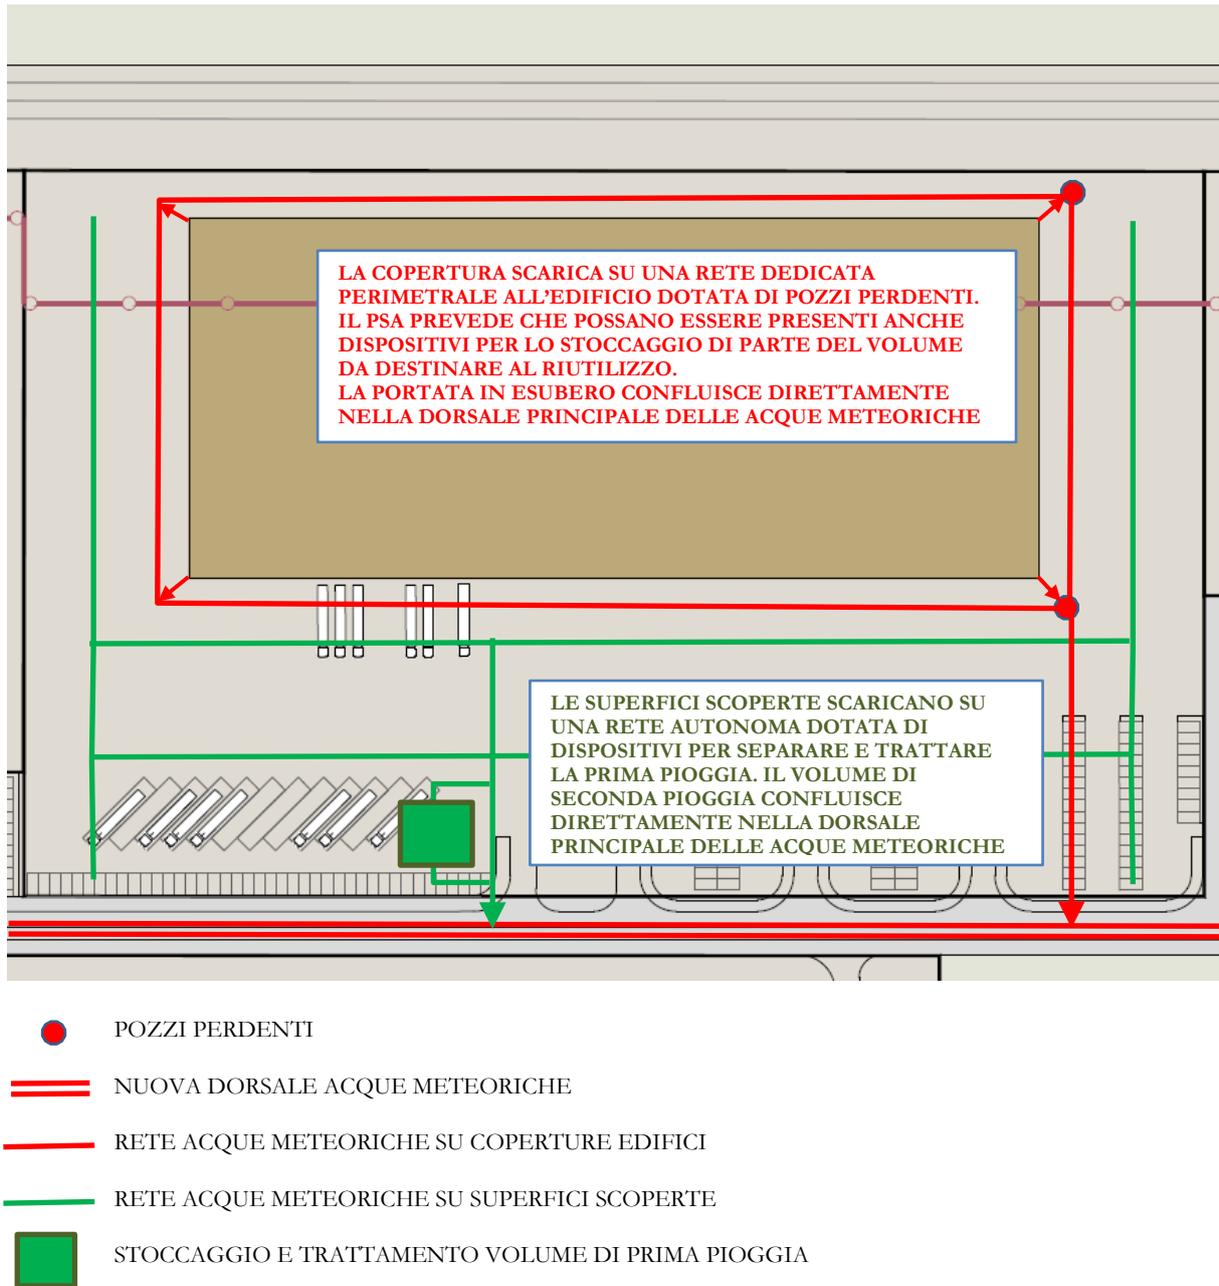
Schema concettuale del sistema idraulico da realizzare su ciascun lotto d'intervento.
